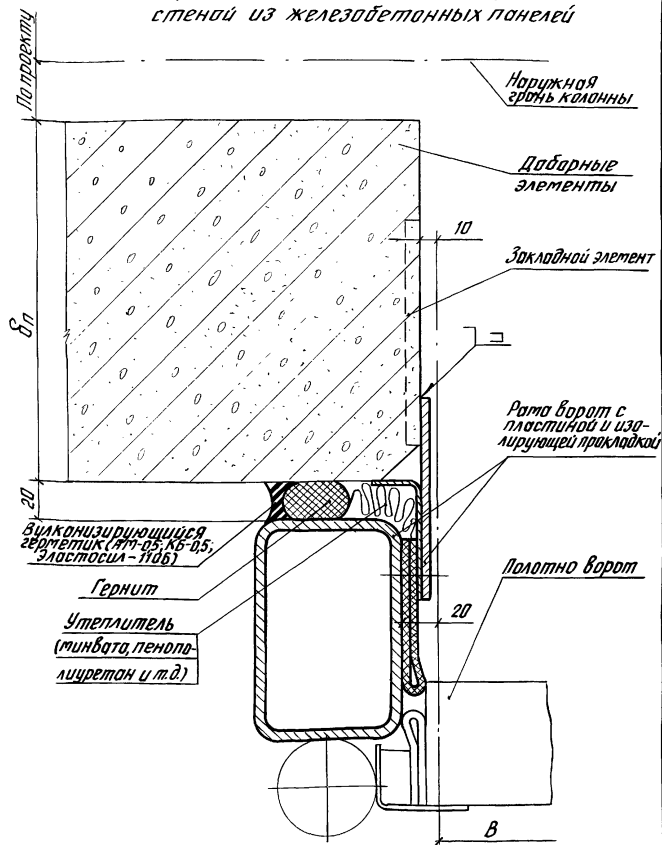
Пример сопряжения ригеля рамы со стеной из железобетонных панелей
